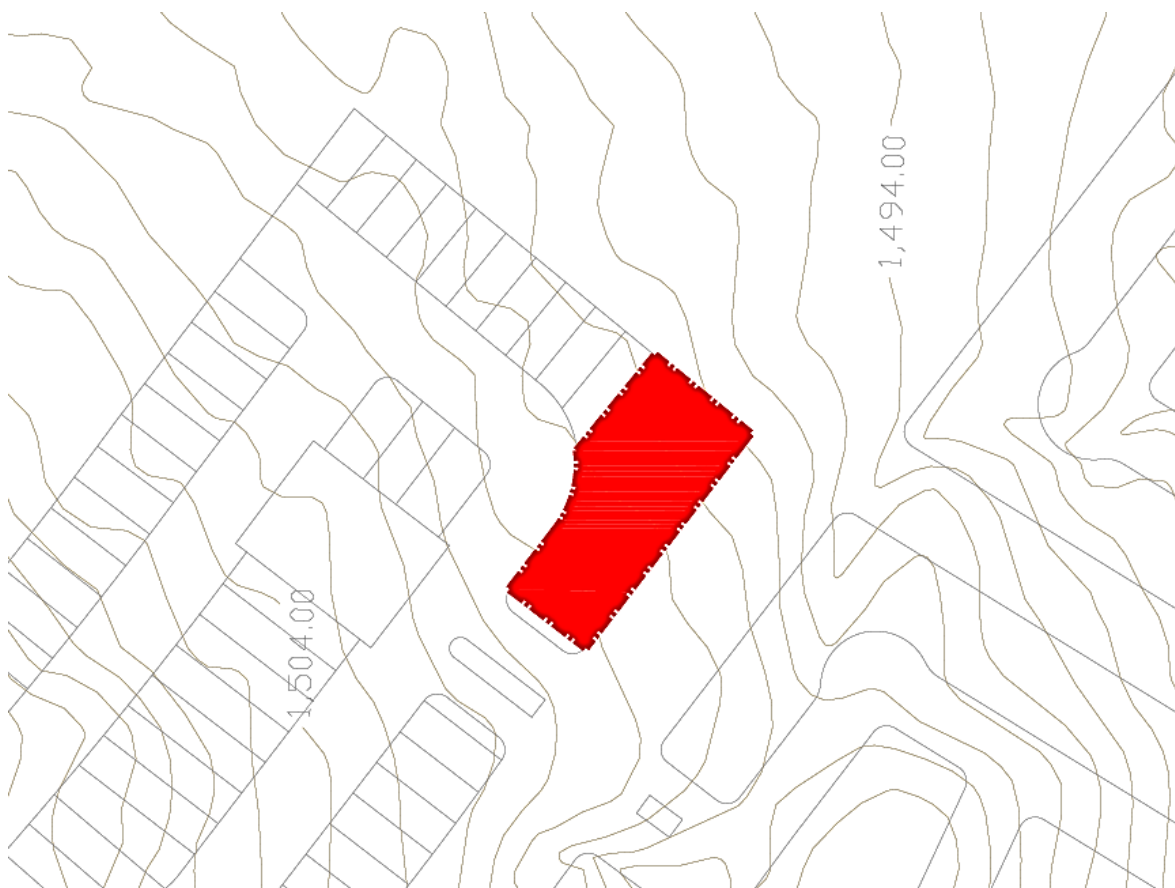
Plano topográfico. Fuente: Elaboración propia.
